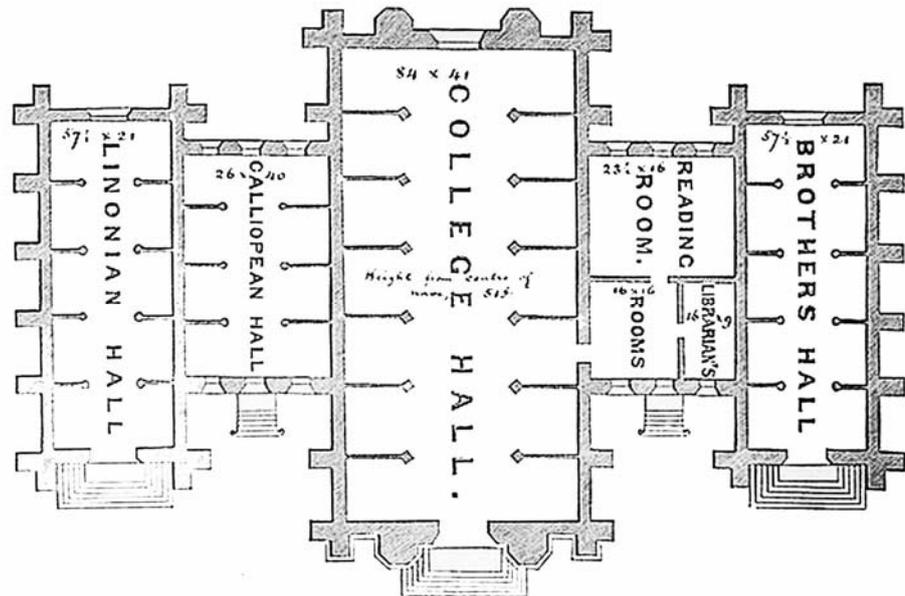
14: Yale College Library, Grundriss
